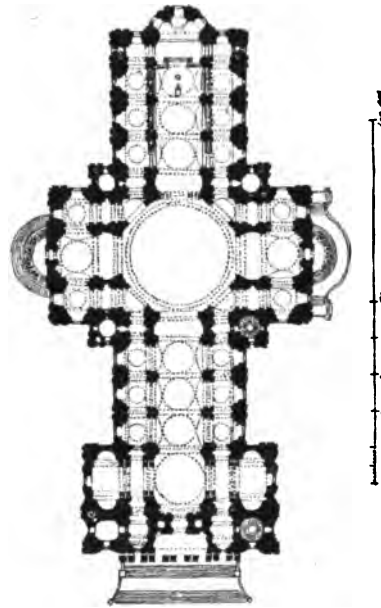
Grundriss von St. Paul in London (n. Gailhabaud).
